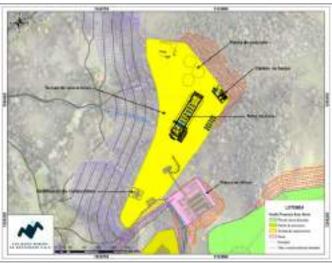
Vista de la terraza de operaciones sector Padilla, el taller de mantenimiento, la planta de concreto y la Estación de Servicio
